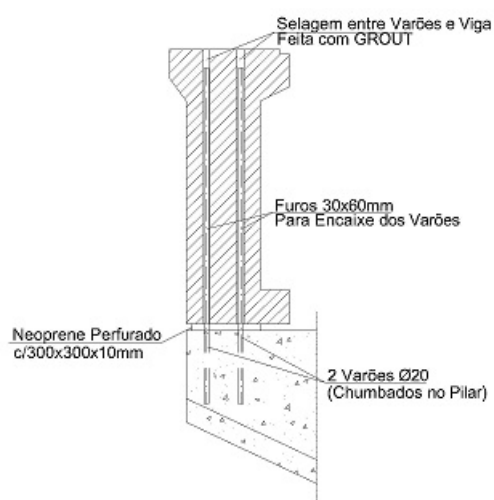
Pormenor de fixação da viga ao pilar [18]
